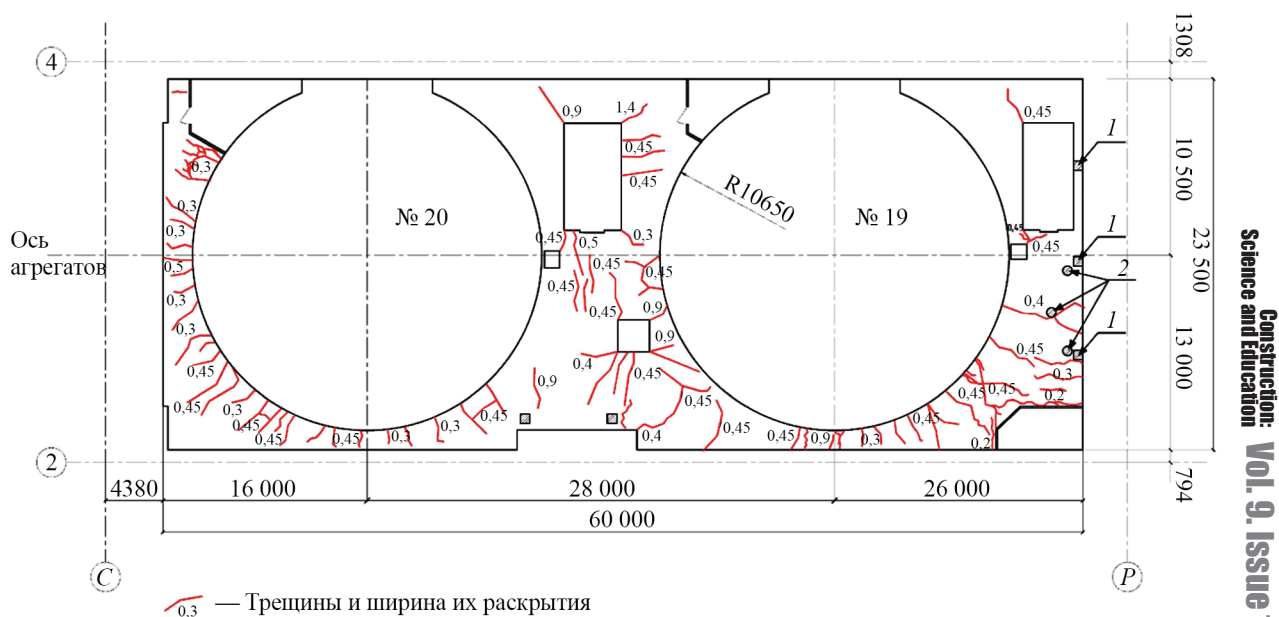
Схема расположения трещин в перекрытии машинного зала отм. 41,3 м нижняя грань (секция № 10): 1 — проектные колонны; 2 — дополнительные стальные опоры
